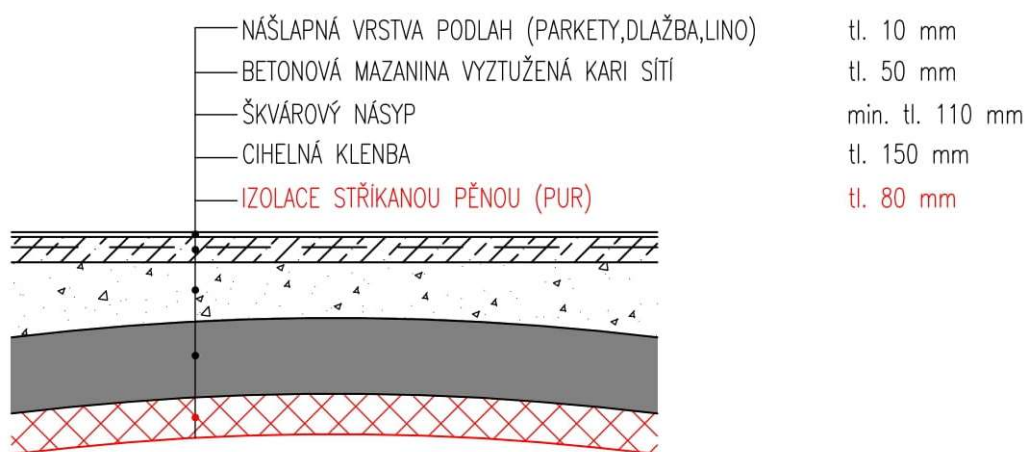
Zateplení stropní konstrukce 1. PP – varianta 1
